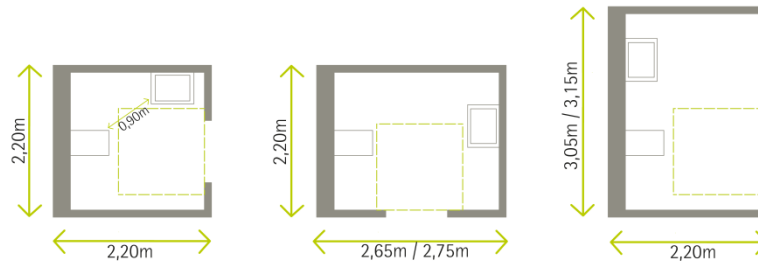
exemplarische Grundrisse barrierefreier Sanitärräume
